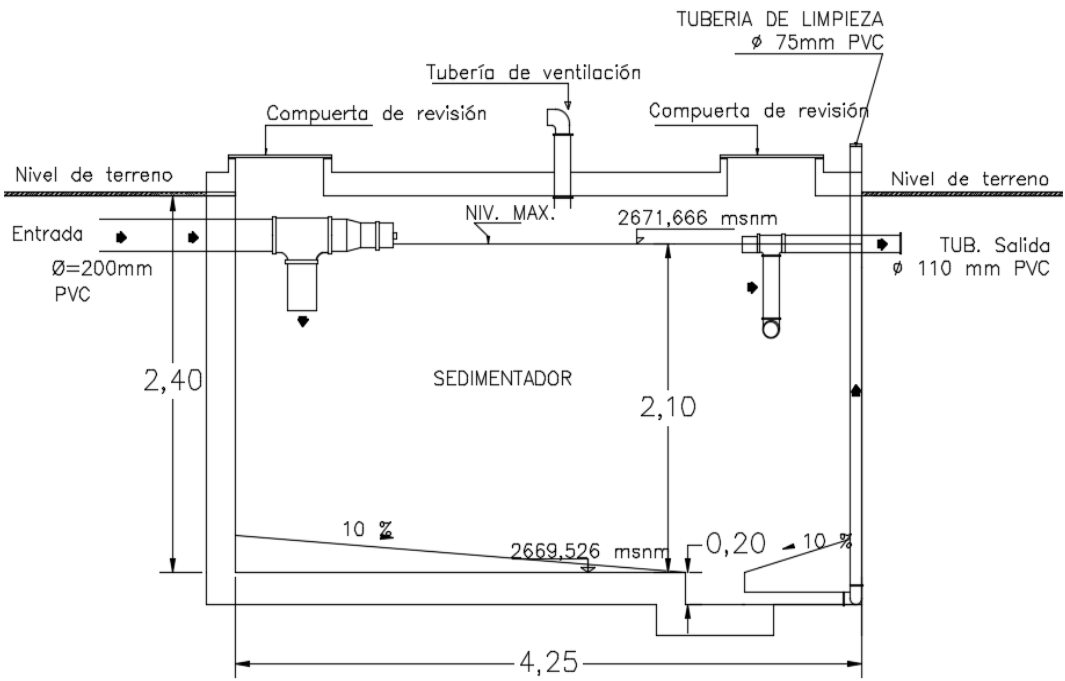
Vista de perfil sedimentador planta No. 14. Basado en Moscoso (2006).
